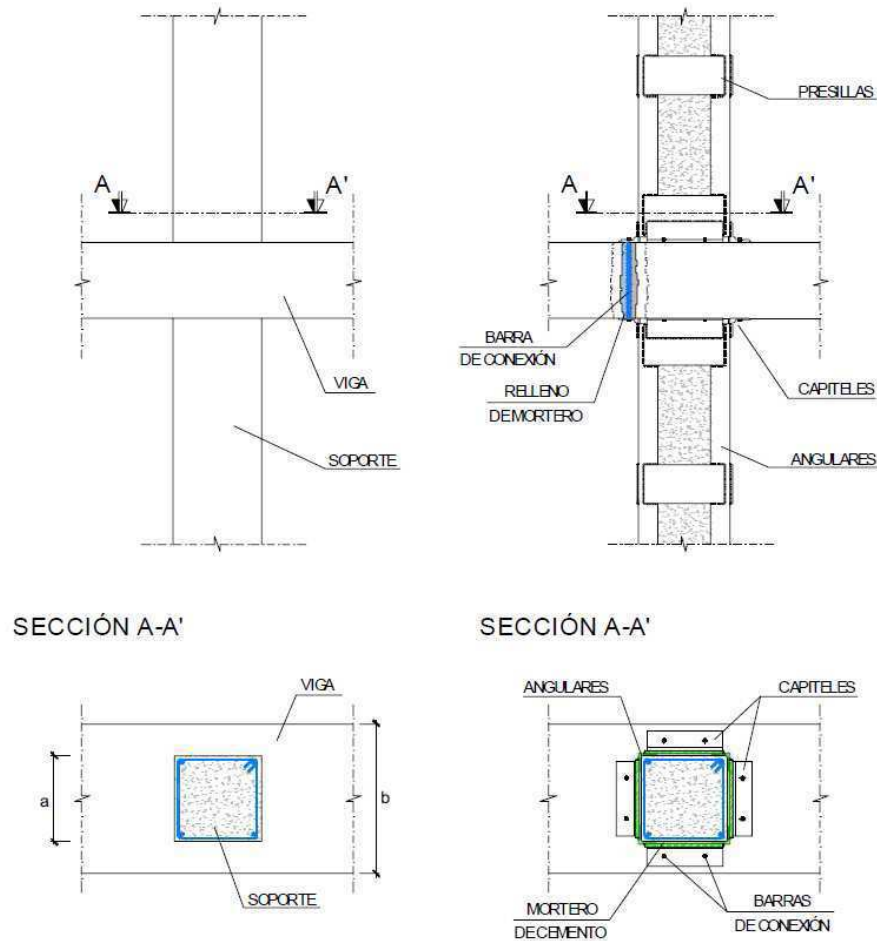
Conexión entre tramos de soporte de diferente planta mediante barras de acero pasantes (Adam 2007)
